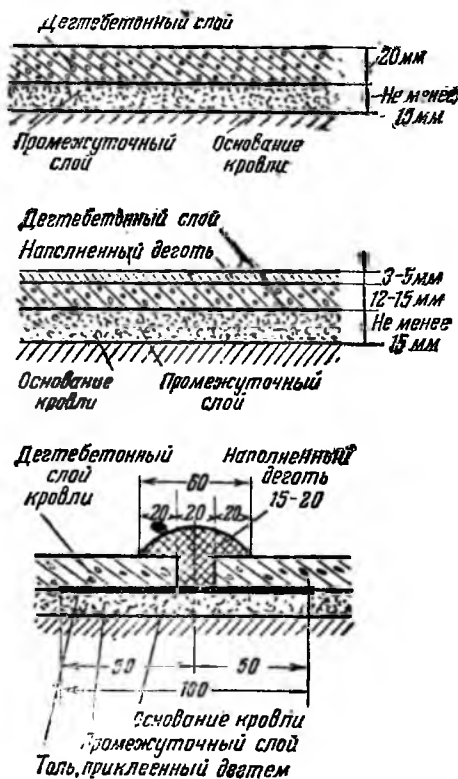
Однослойная и двухслойная дегтебетонная кровля
